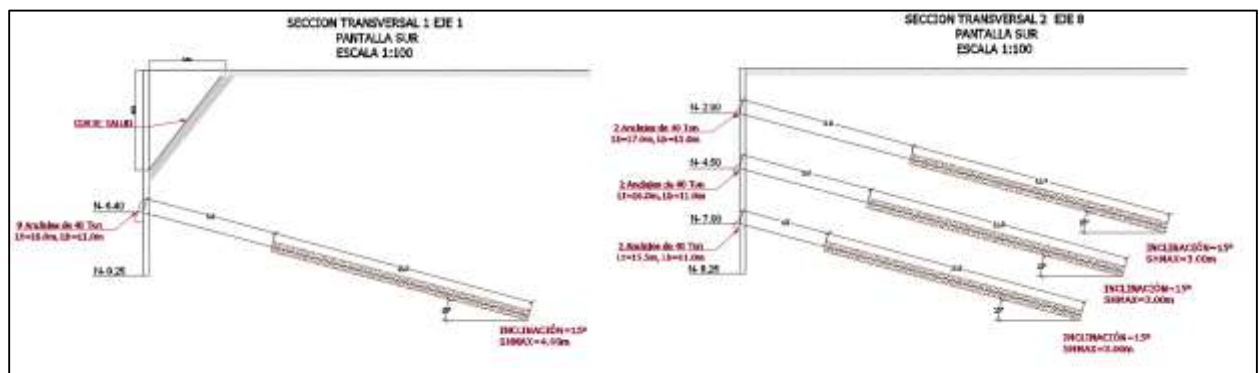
Secciones Transversales Pantalla Sur - Proyecto San Agustín
